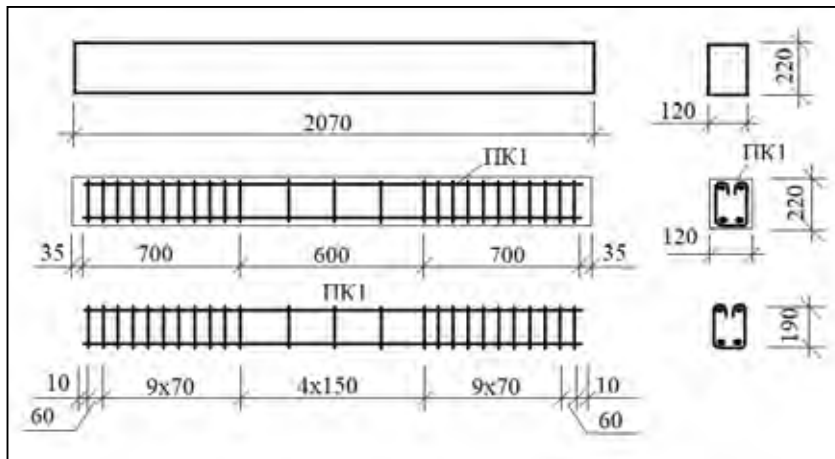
Опалубочне та арматурне креслення балок серії БМ
